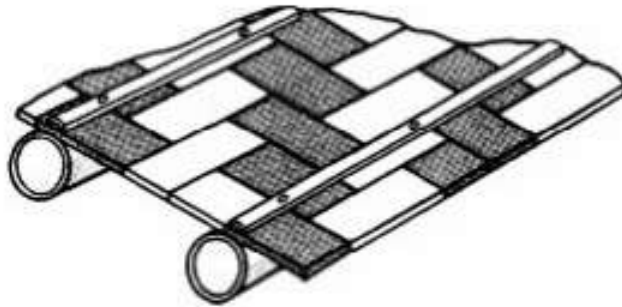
Esquema de pregagem das esteiras ao pavimento [10]
